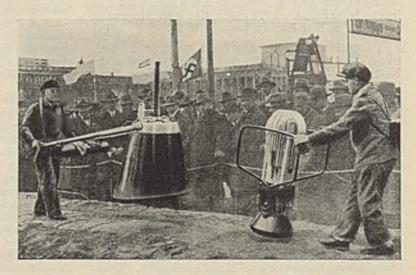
"Delmag" - Explosionsstampfer (links 500 kg, rechts 200 kg schwer).
